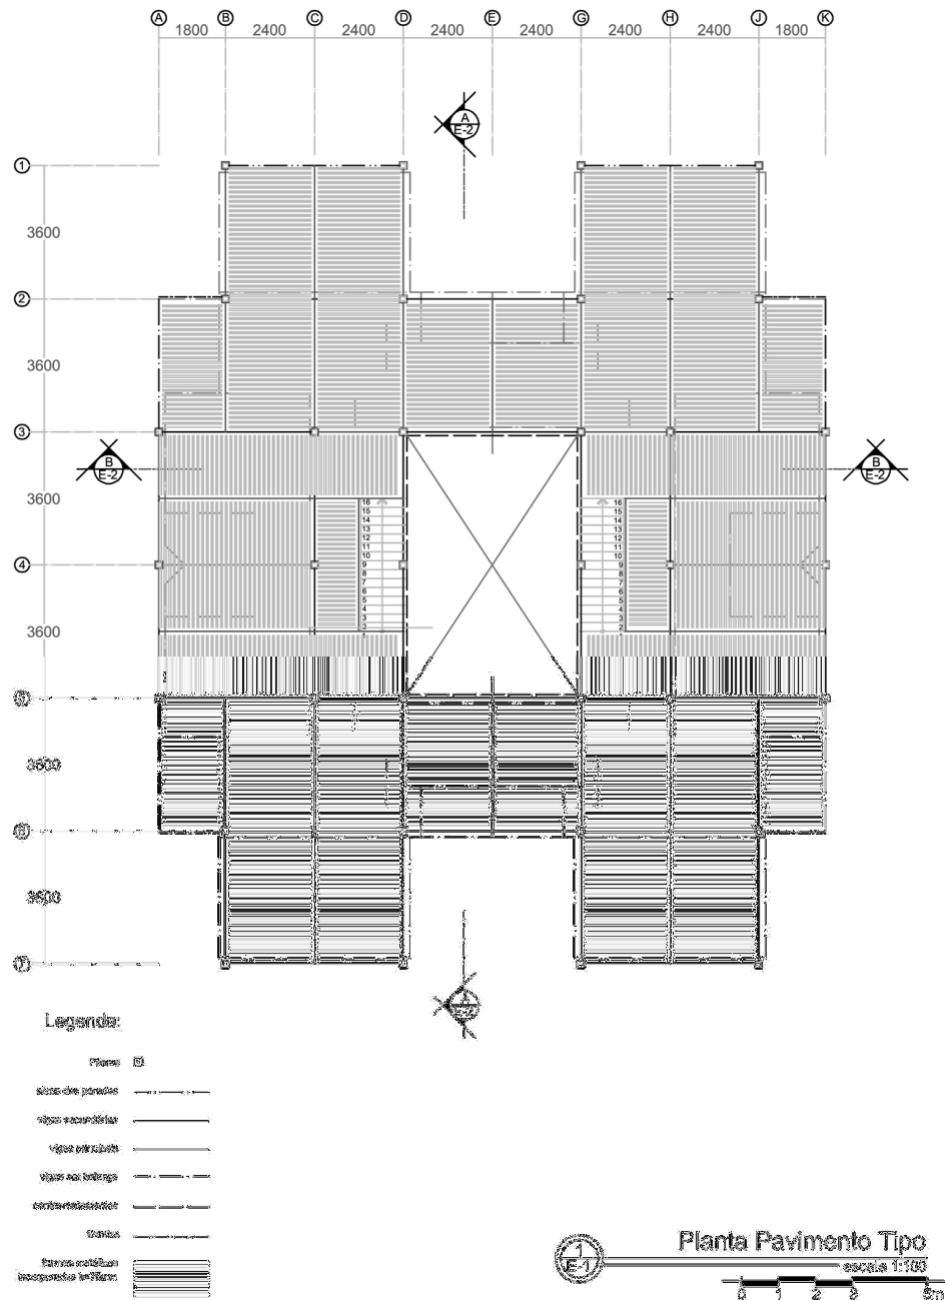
Estrutura – Planta pavimento tipo. Fonte: Arquivo do autor
